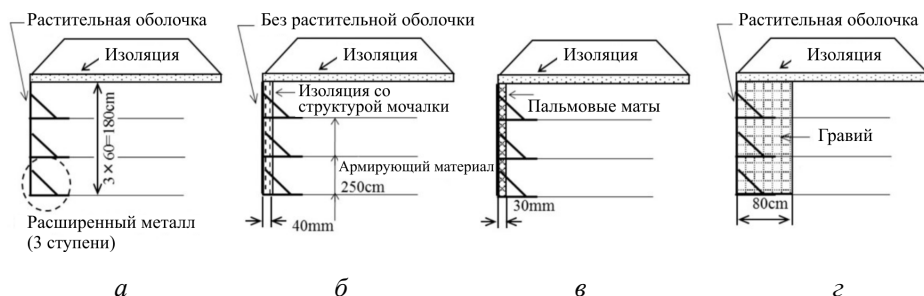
Модели конструкций армогрунтовых подпорных стен:
